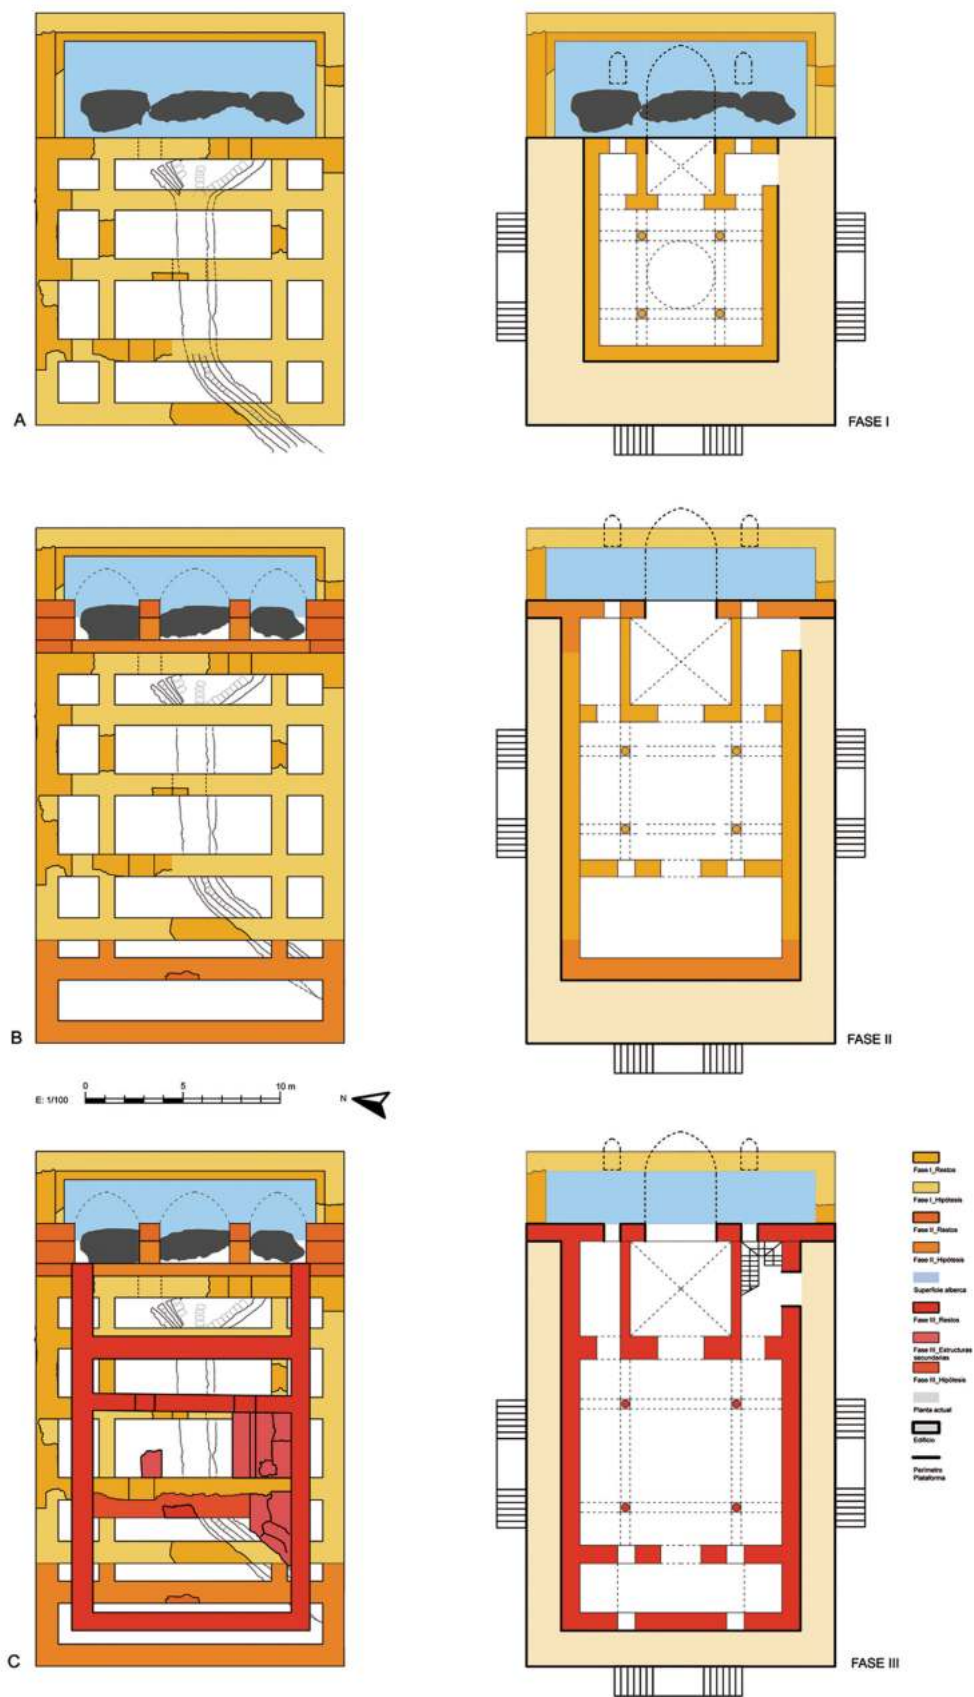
Palermo, Cuba Soprana. Planta de las tres fases.
